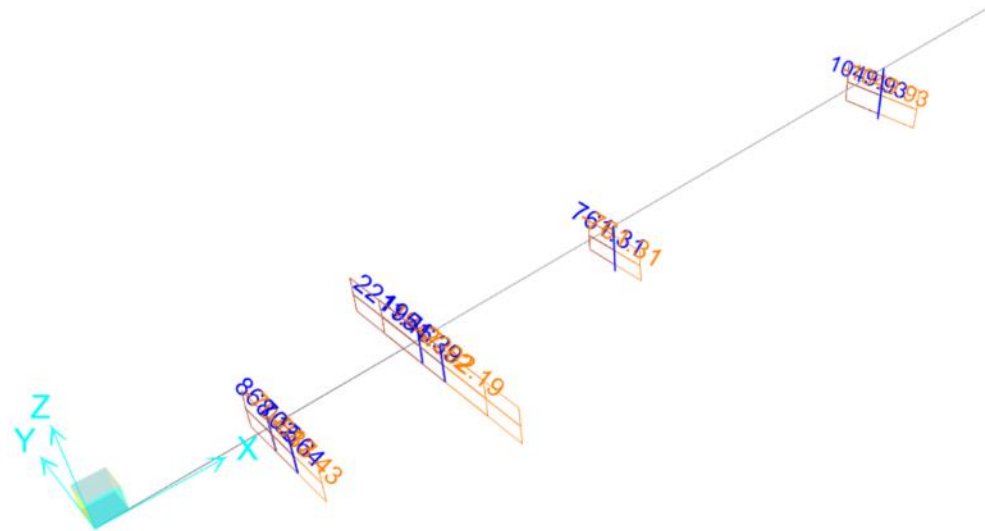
Diagrama cortante transversal (KN) de las columnas puente San Pedro
